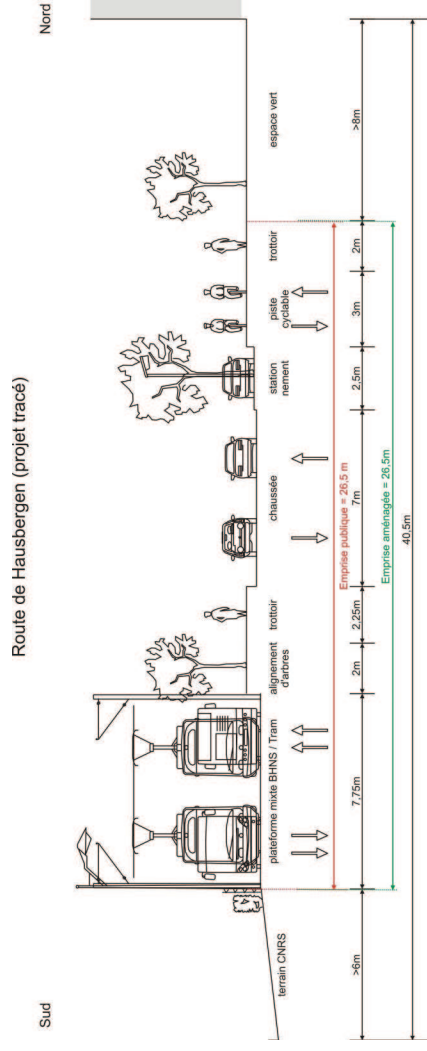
Situation projetée (coupe 17) sur la route de Hausbergen
